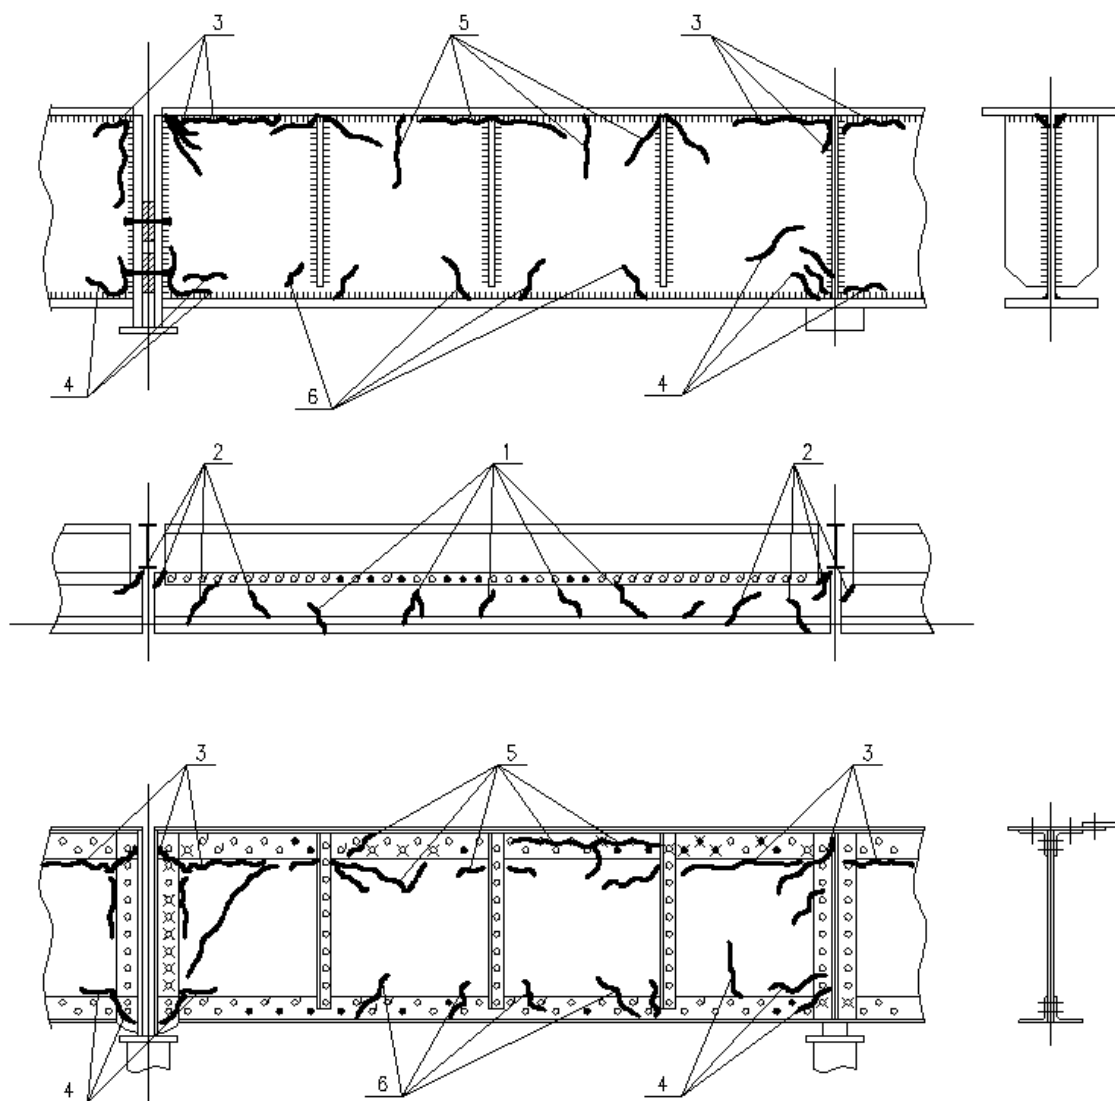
Распределение дефектов в сварных и клепаных подкрановых балках: 1- в тормозной площадке в пролете; 2- то же у опоры; 3- в верхнем поясе балки у опоры; 4- в нижнем поясе у опоры; 5- в верхнем поясе балки в пролете; 6- в нижнем поясе балки в пролете.
